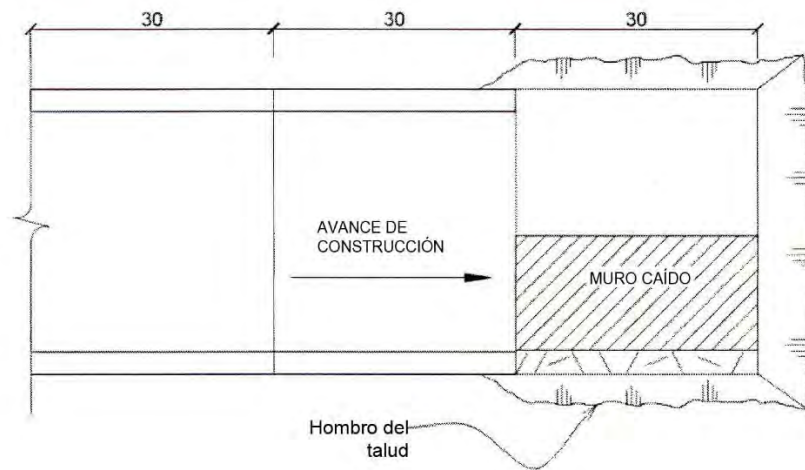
Vista en planta del muro fallado por el empuje hidrostático.
